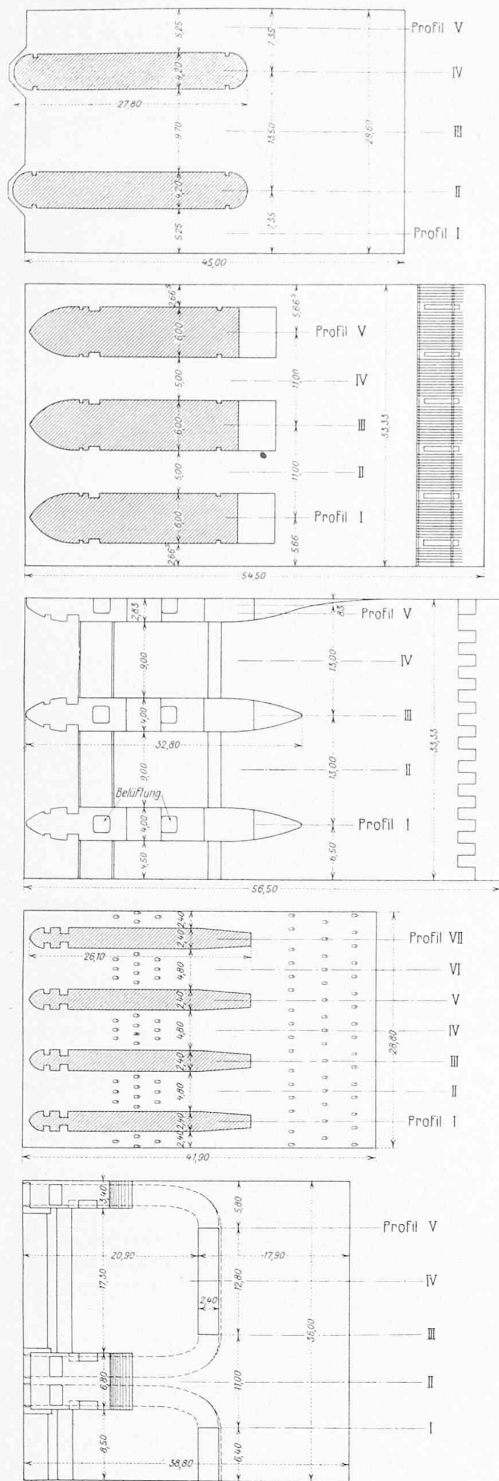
Grundrisse der im Modell untersuchten Teilstücke der Wehre.
